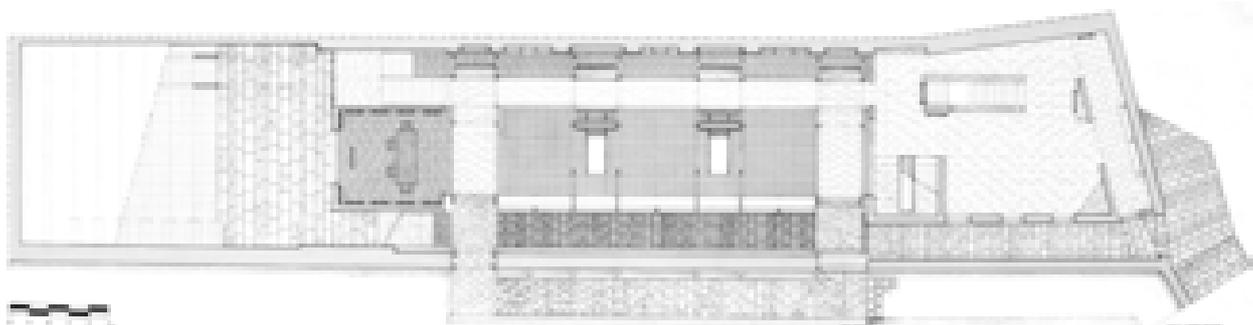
Pianta piano– Bruno Sacchi – 13/11/1997 (AABS-95.638)
